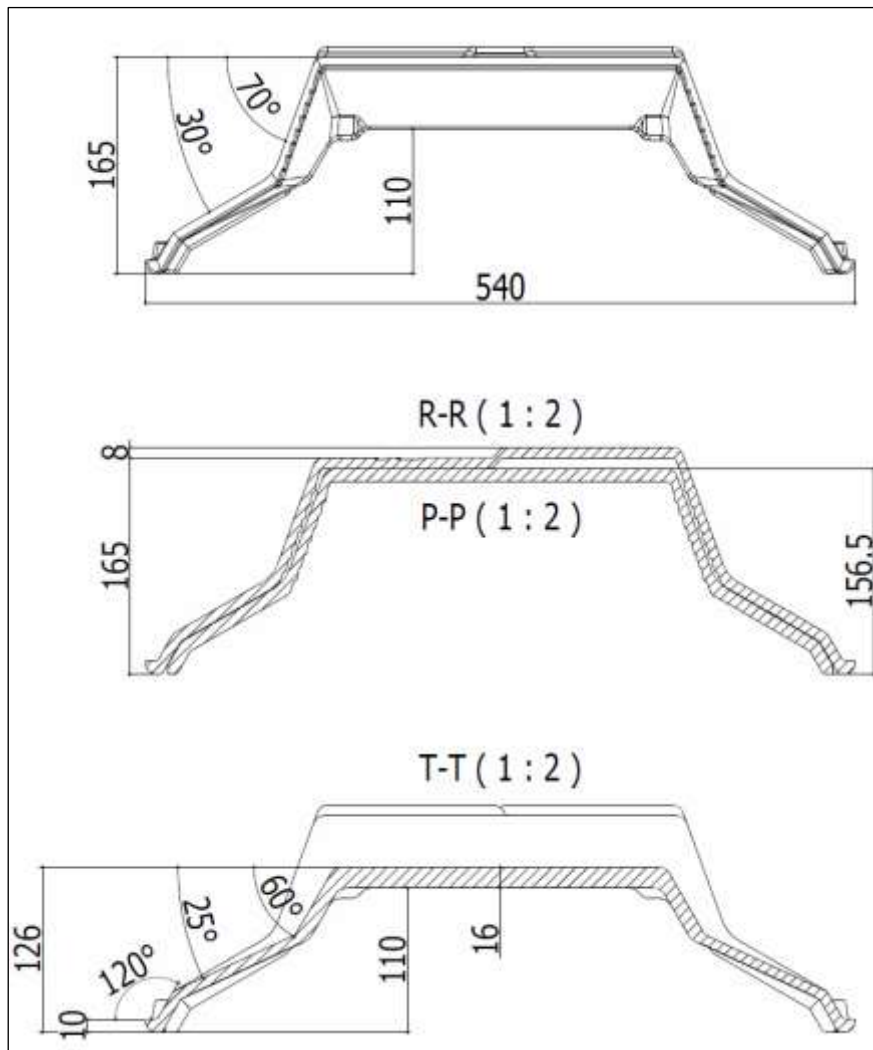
Entrevous Fabribois ou Duranlight (longueur 1200 mm) Hauteur coffrante 200 mm
